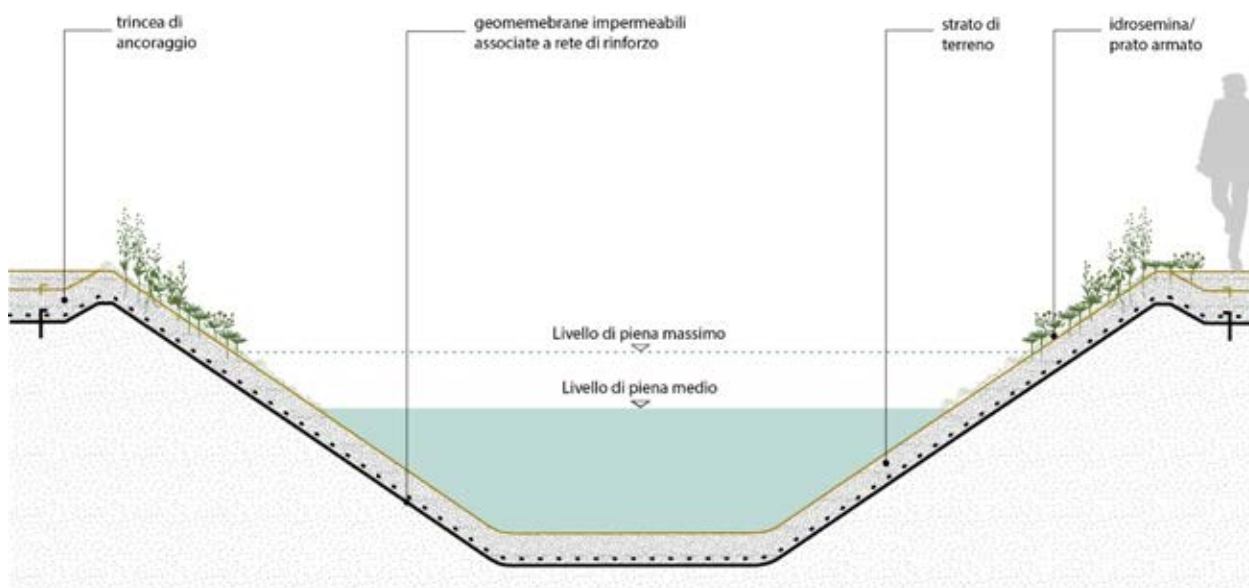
Sezione tipo – utilizzo di geomembrane impermeabili in associazione con interventi di idrosemina o messa a dimora di talle forestali (rielaborazione da Sistemi di protezione spondale Borghi Azio spa)
